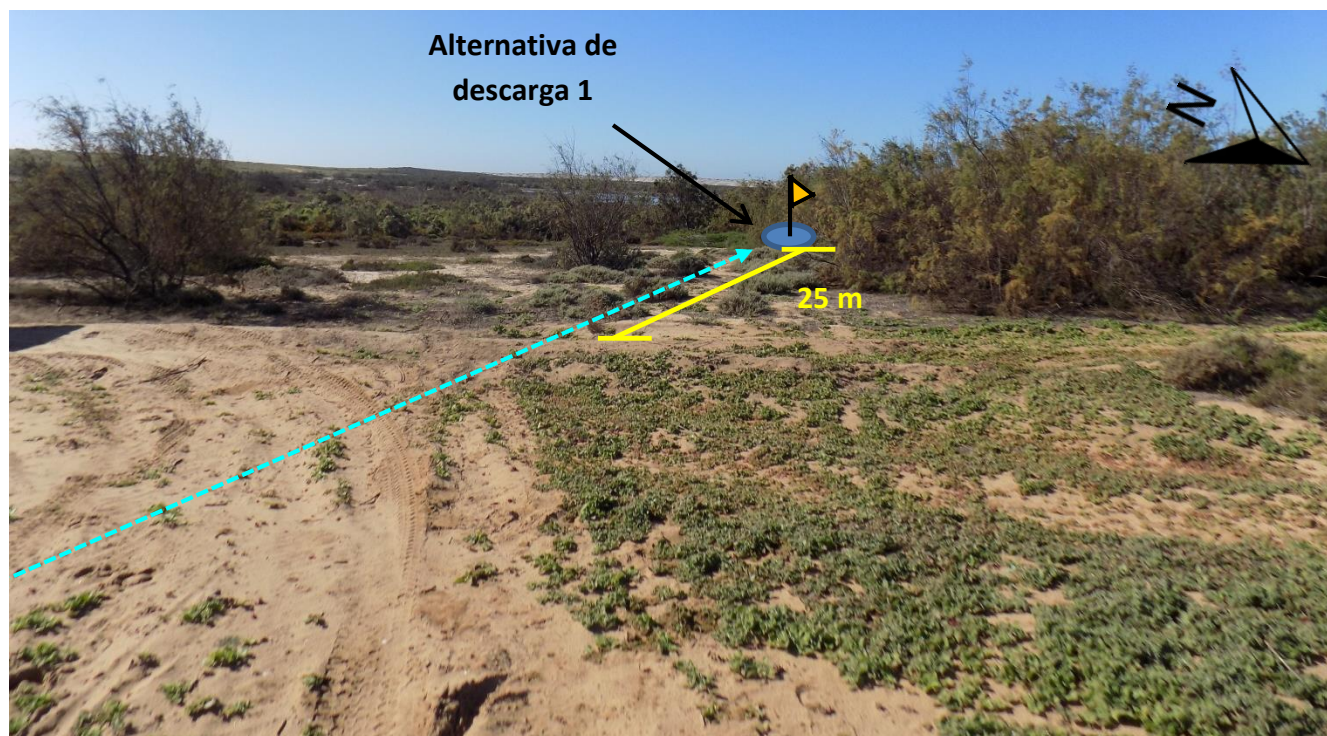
Sección final de la tubería de conducción de agua de rechazo y punto de descarga.
